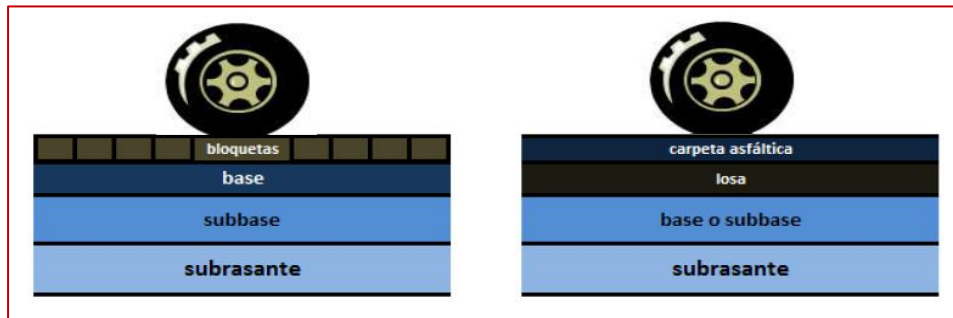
Esquema típico del paquete estructural de pavimentos mixtos.
